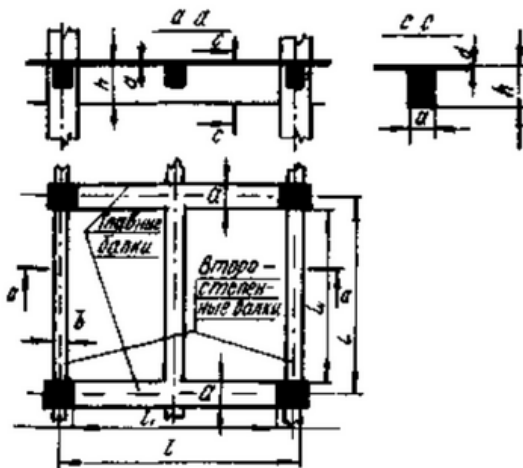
Фрагмент железобетонного ребристого перекрытия
